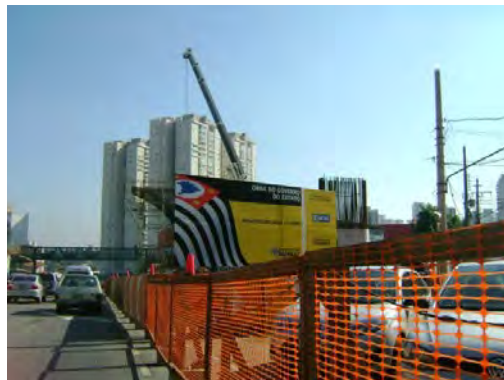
Obras de implantação do Sistema Monotrilho – Distrito Campo Belo
